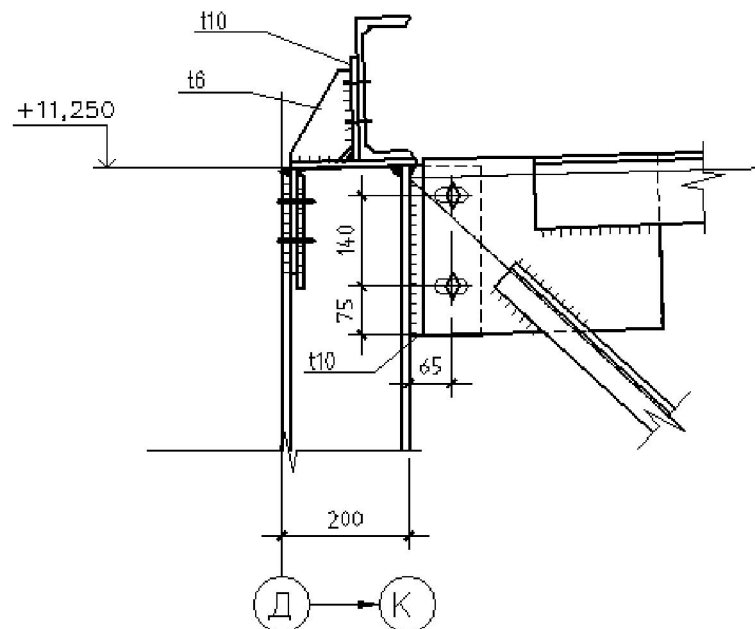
Узел крепления верхнего пояса фермы к надколоннику.
